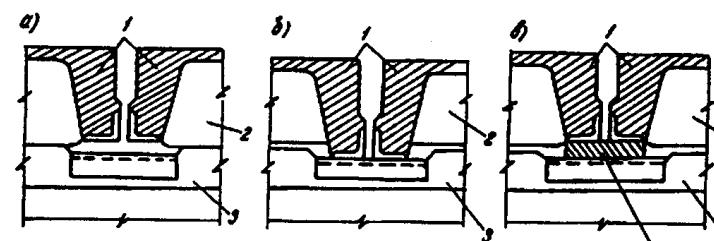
Схема дефекта узла опирания плит перекрытий на ригели и его исправления в каркасных зданиях серий ИИ-20/70 и 1.420-12 (а — при одинаковой высоте продольных и торцевых поперечных ребер; б — при уменьшении высоты торцевого поперечного ребра; в — при установке стальных прокладок):
